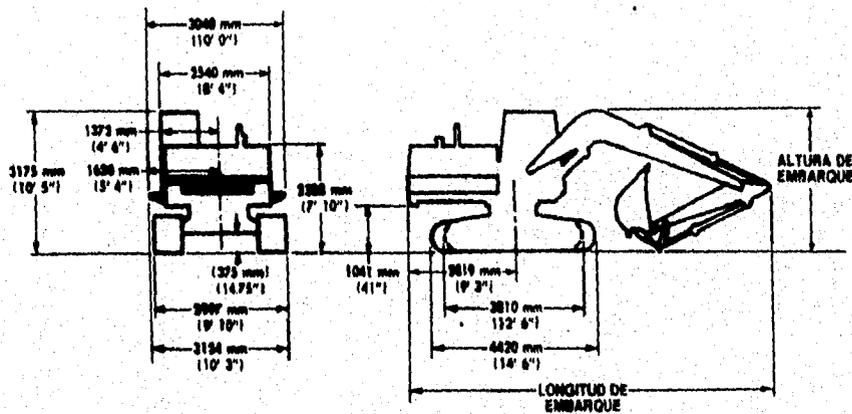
Excavadora montada sobre orugas, indicando sus dimensiones de embarque.
